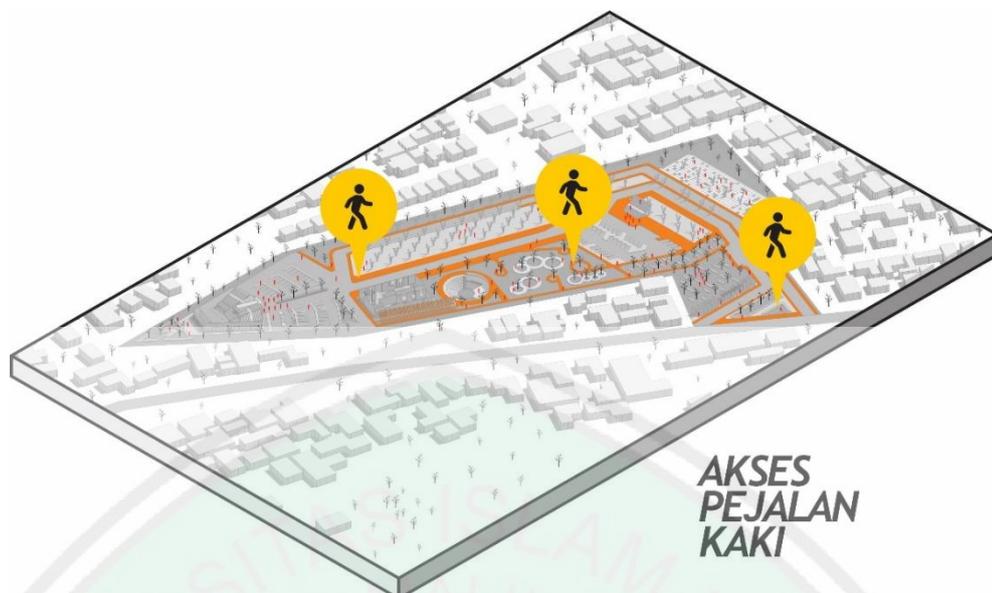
Layout Plan Kawasan Taman Kepustakaan Sastra
